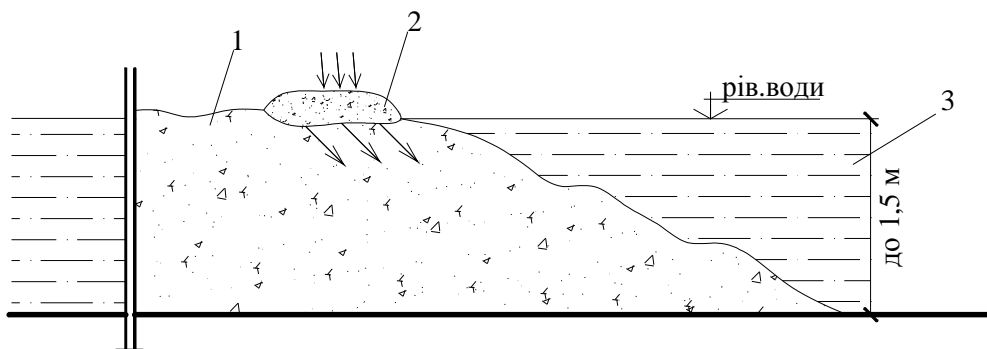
Бетонування методом утримування бетонної суміші:
